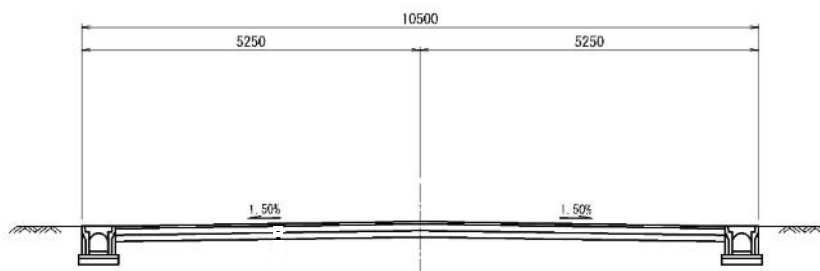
(8) 標準断面図 (特殊道路 幅員 10.5m)
